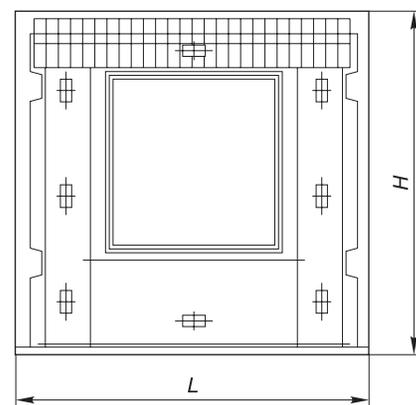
Общий вид и армирование трехслойной наружной стеновой панели с железобетонными шпонками
